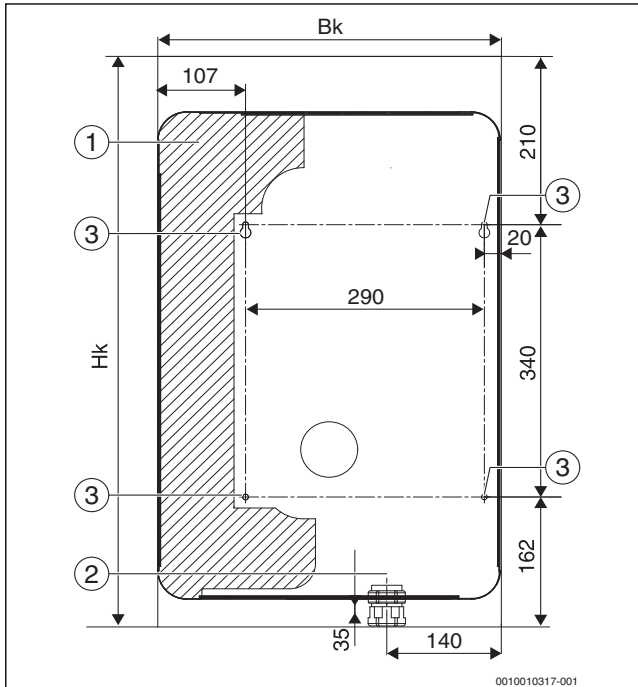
Abmessungen der Bohrungen für das Befestigen des Heizkessels an der Wand und für das Versorgungskabel beim Heizkessel Tronic Heat 3500 15-24 kW
